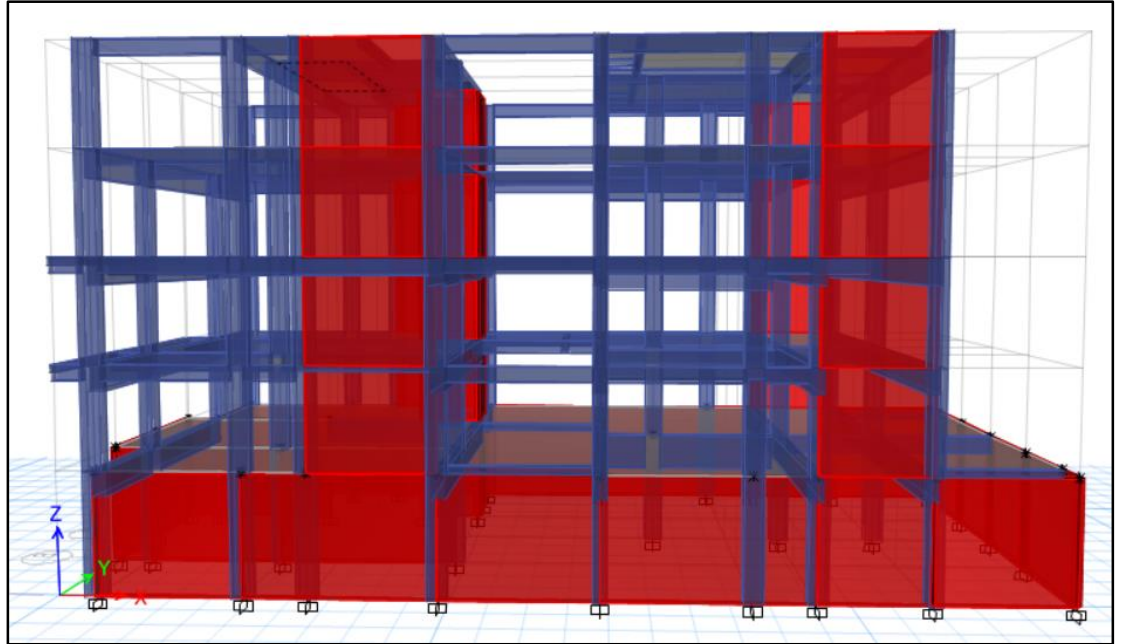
Modelamiento de la estructura. Vista eje X-X. Fuente Etbas.
